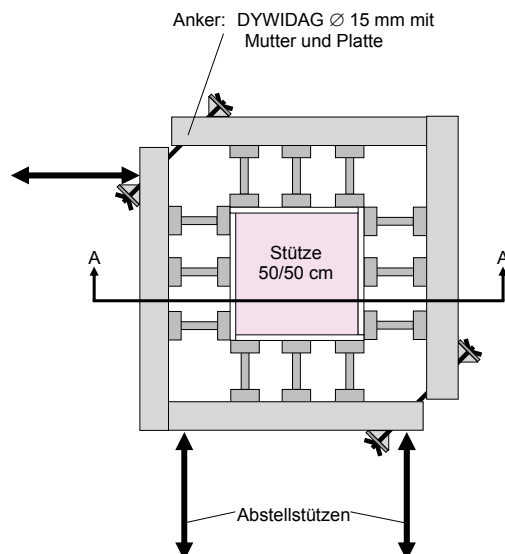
Grundriss: Konstruktion Stützenschalung
